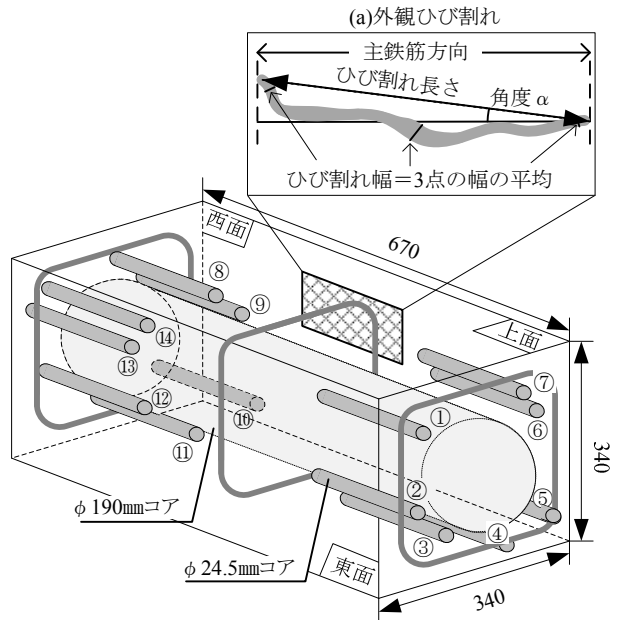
ひび割れ観察箇所とひび割れ計測方法
